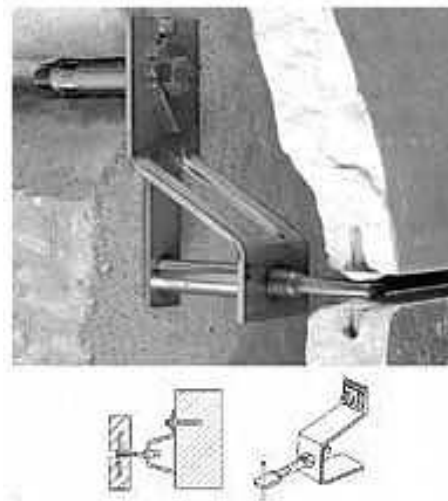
Скрытое крепление на штифтах для плит из натурального гранита толщиной
